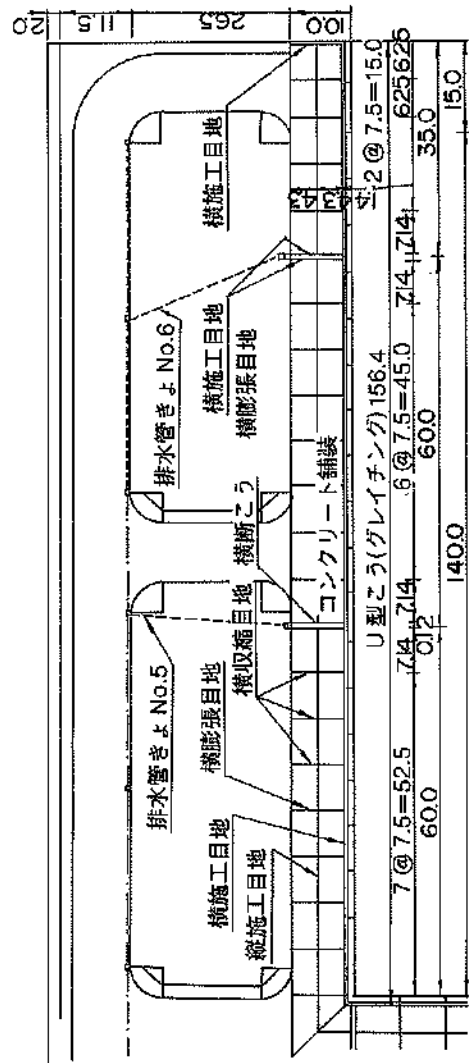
平面図・縦断面図・施設位置図 (③・④)西-2.5m 物揚場
